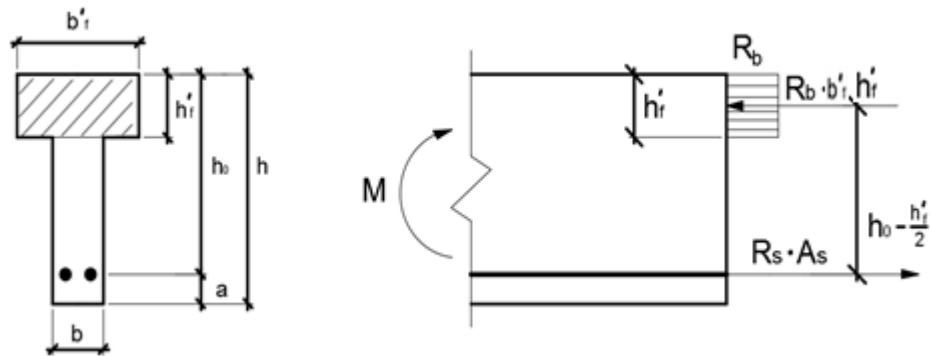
Схема усилий в изгибаемом элементе таврового сечения, когда граница сжатой зоны расположена на границе между полкой и стенкой
